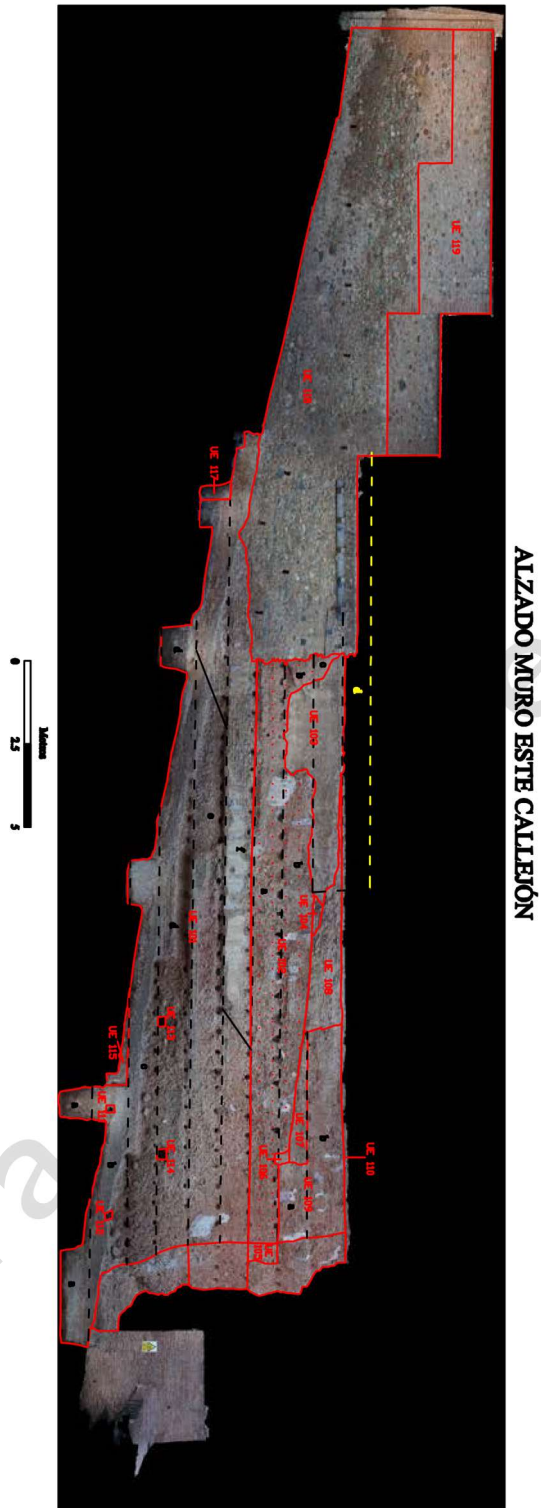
Alzado y análisis estratigráfico murario del muro este del callejón
